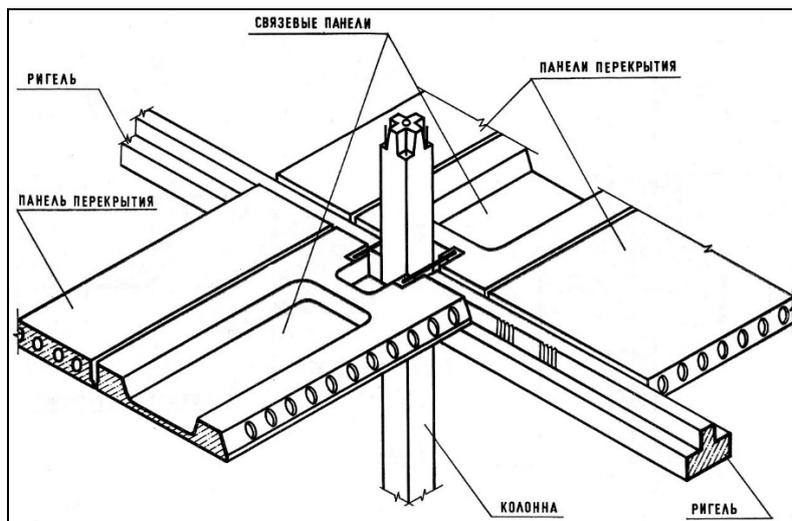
Шарнирный узел сопряжения элементов типового сборного железобетонного связевого каркаса [14, рис. 11.6 (б)]
